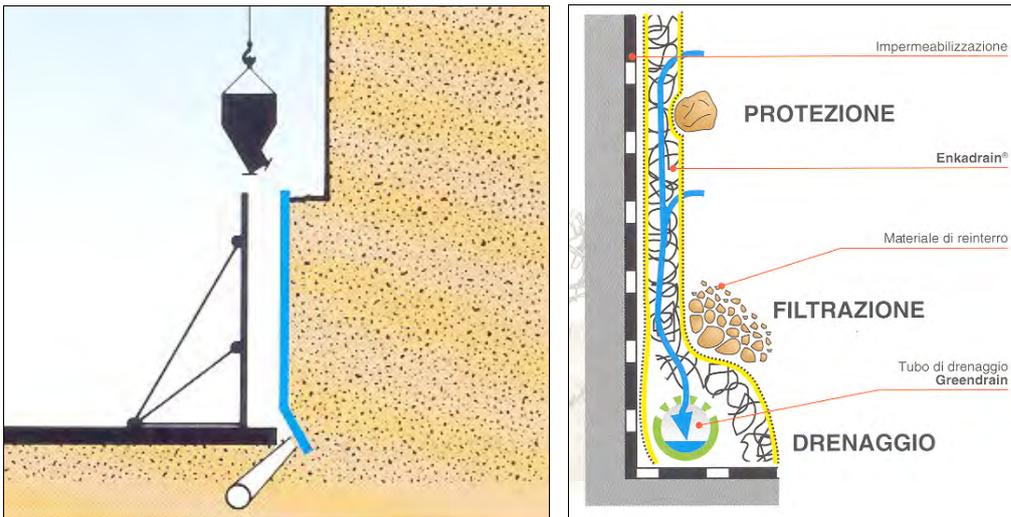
schema di drenaggio verticale realizzato con elemento filtrante sintetico
